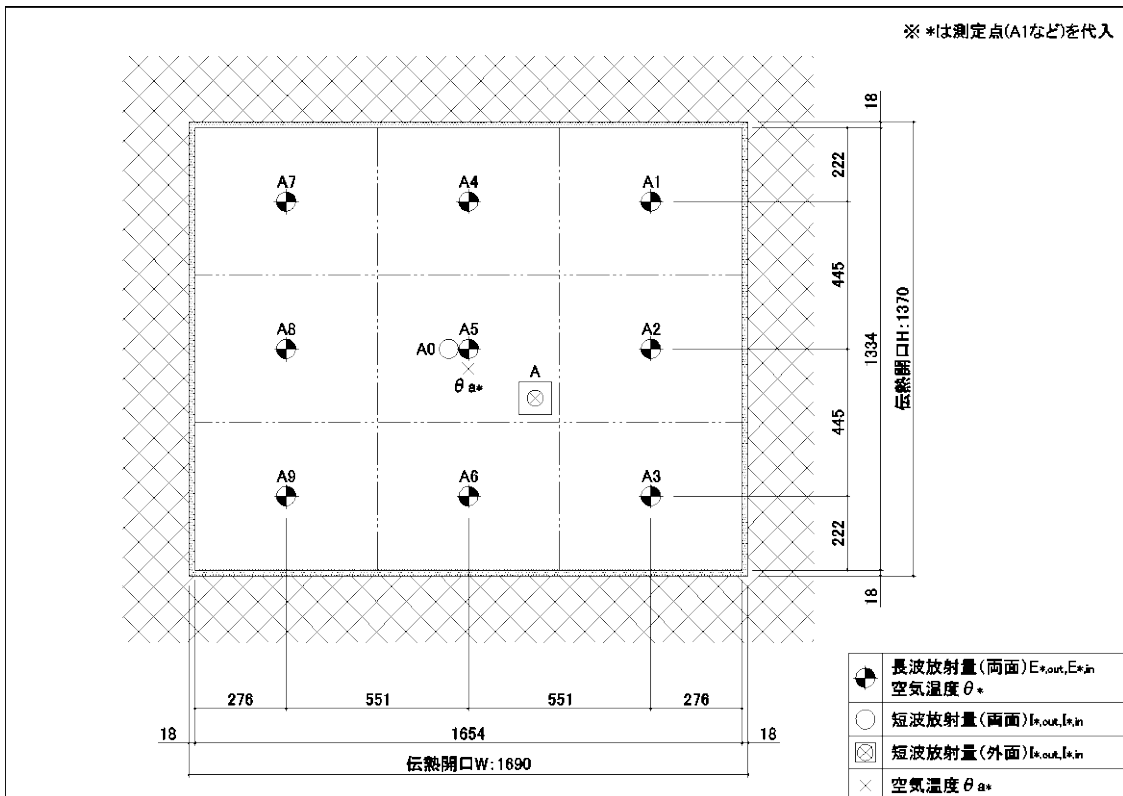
センサー配置図 (外気, Section A, ※内観を示す)
